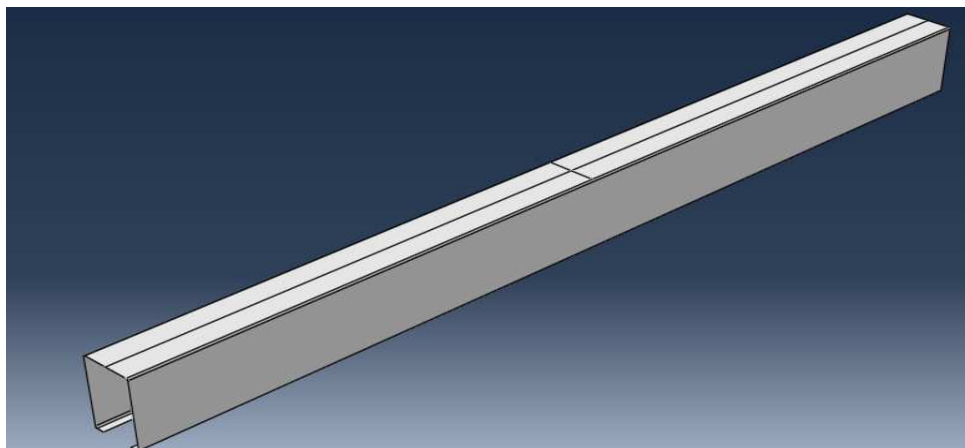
La poutre (C) en 3D sous ABAQUS.
